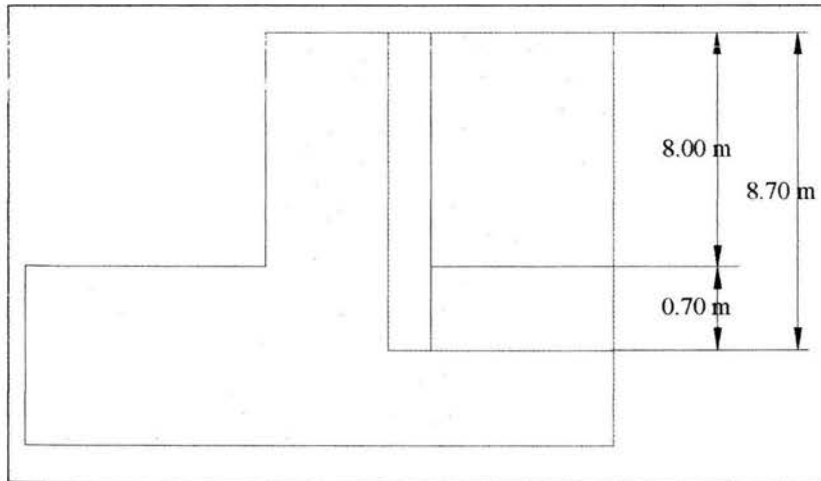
Profundidad de barrenación y sub-barrenación.
